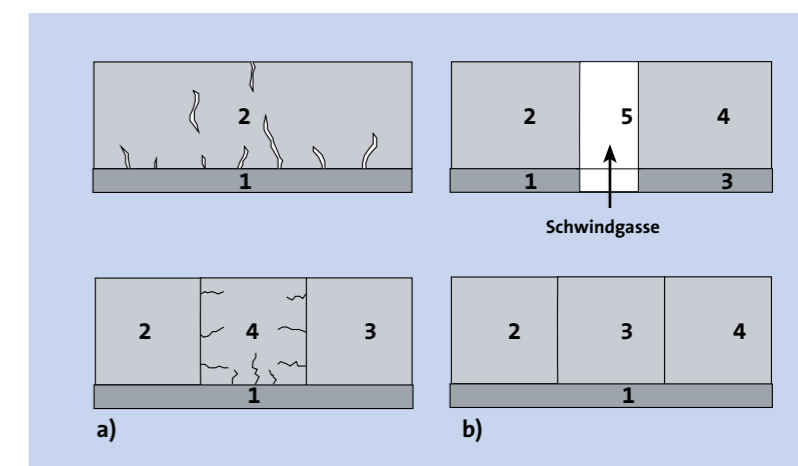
Wahl der Betonierabschnitte bei einer Stützmauer (Längsansicht)
